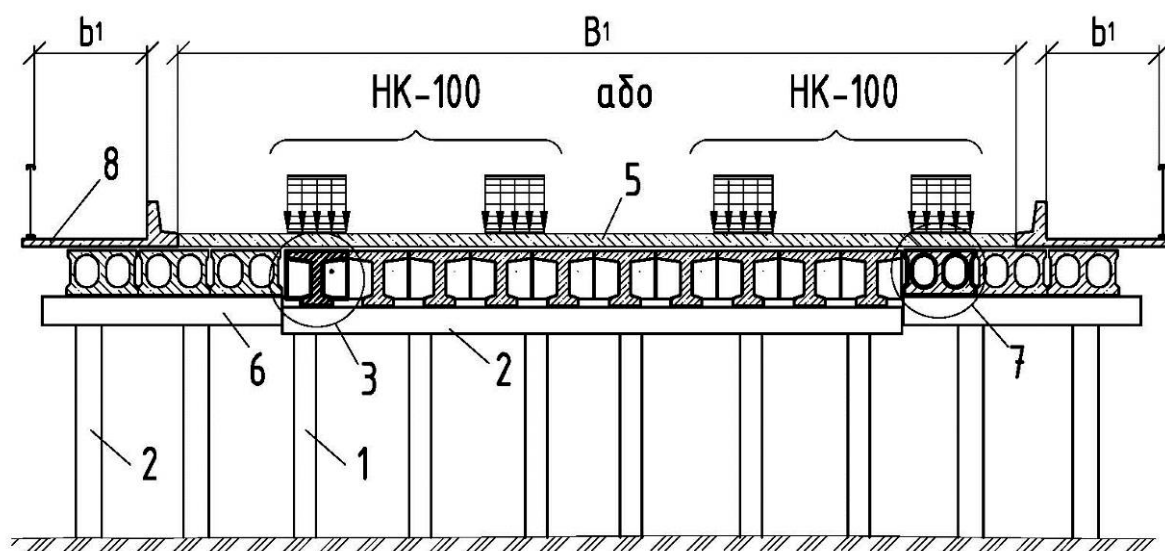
Принципове конструктивне рішення та розрахункова схема поперечника мосту у с. Пултівці до реконструкції. Тут: 1, 2 – палі – колони; 3 – Т-подібна струнобетонна балка; 4, 6 – монолітний ригель; 7 – порожниста мостова плита, 8 – тротуарна плита.
